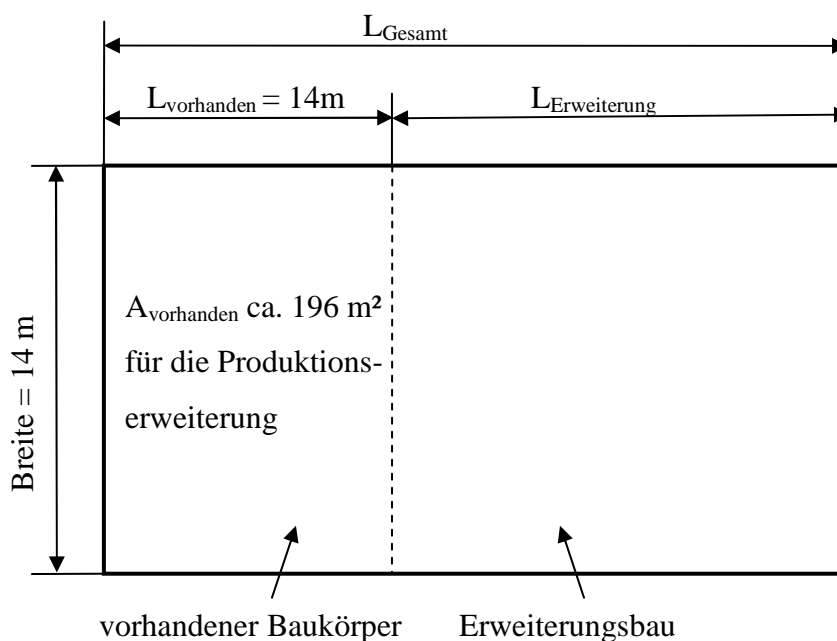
Lageplan der bebauten Produktionsfläche
